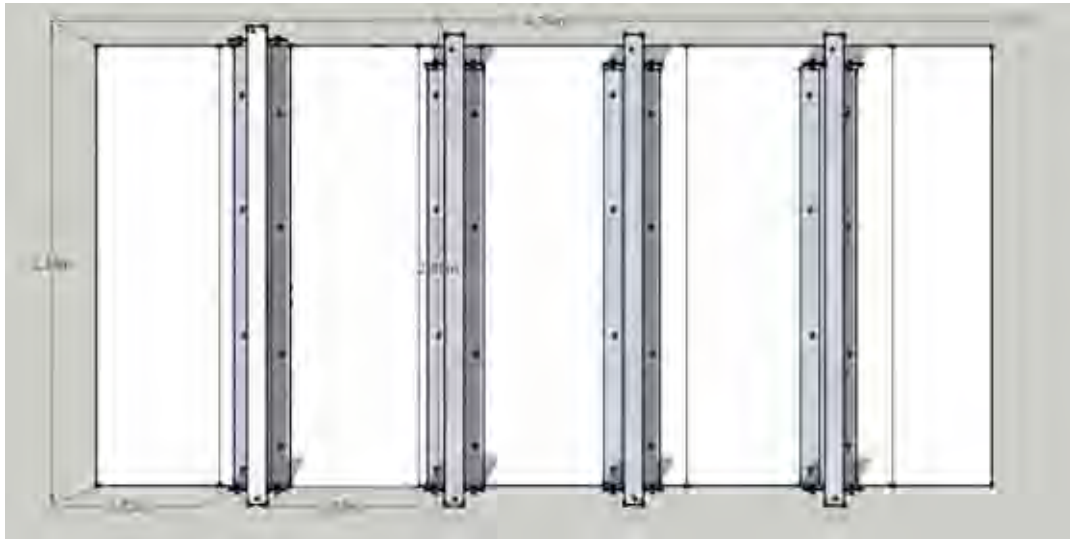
Planta Acotada del Cielo raso.: Elaboración propia 2010
